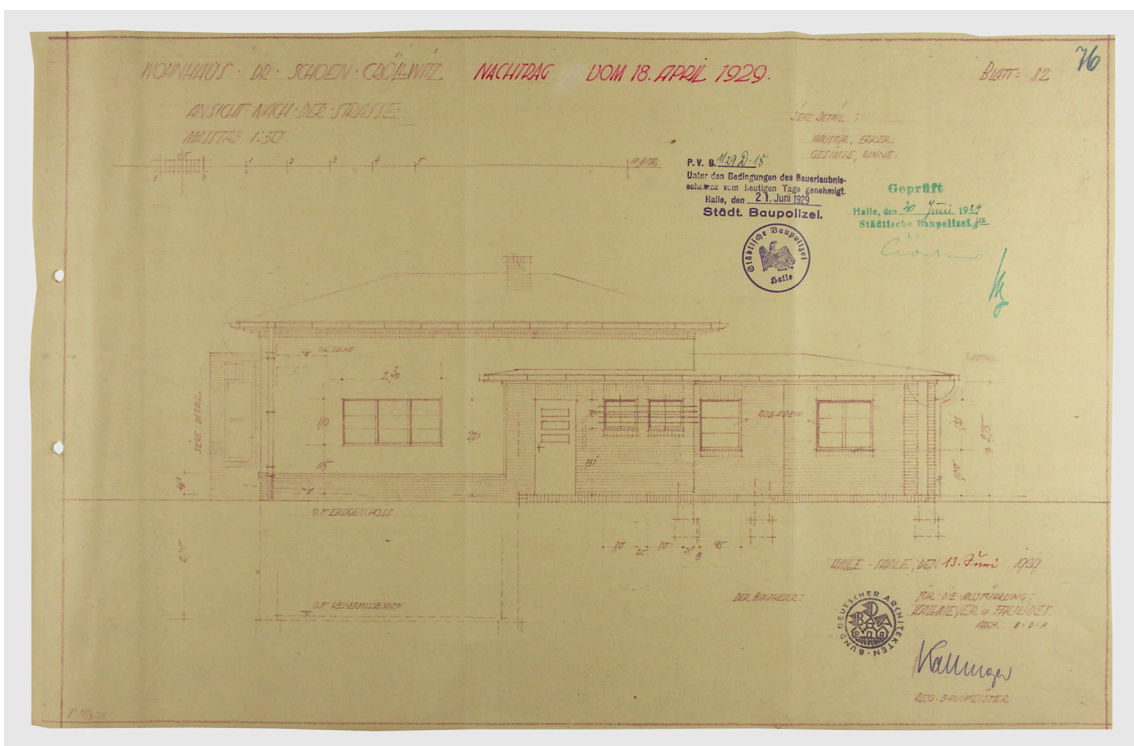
Wohnhaus Dr. Schoen in der Dölauer Straße 82 in Halle, Ansichten, 2. Fassung, 1. Bauabschnitt, datiert 13. Juni 1929.
